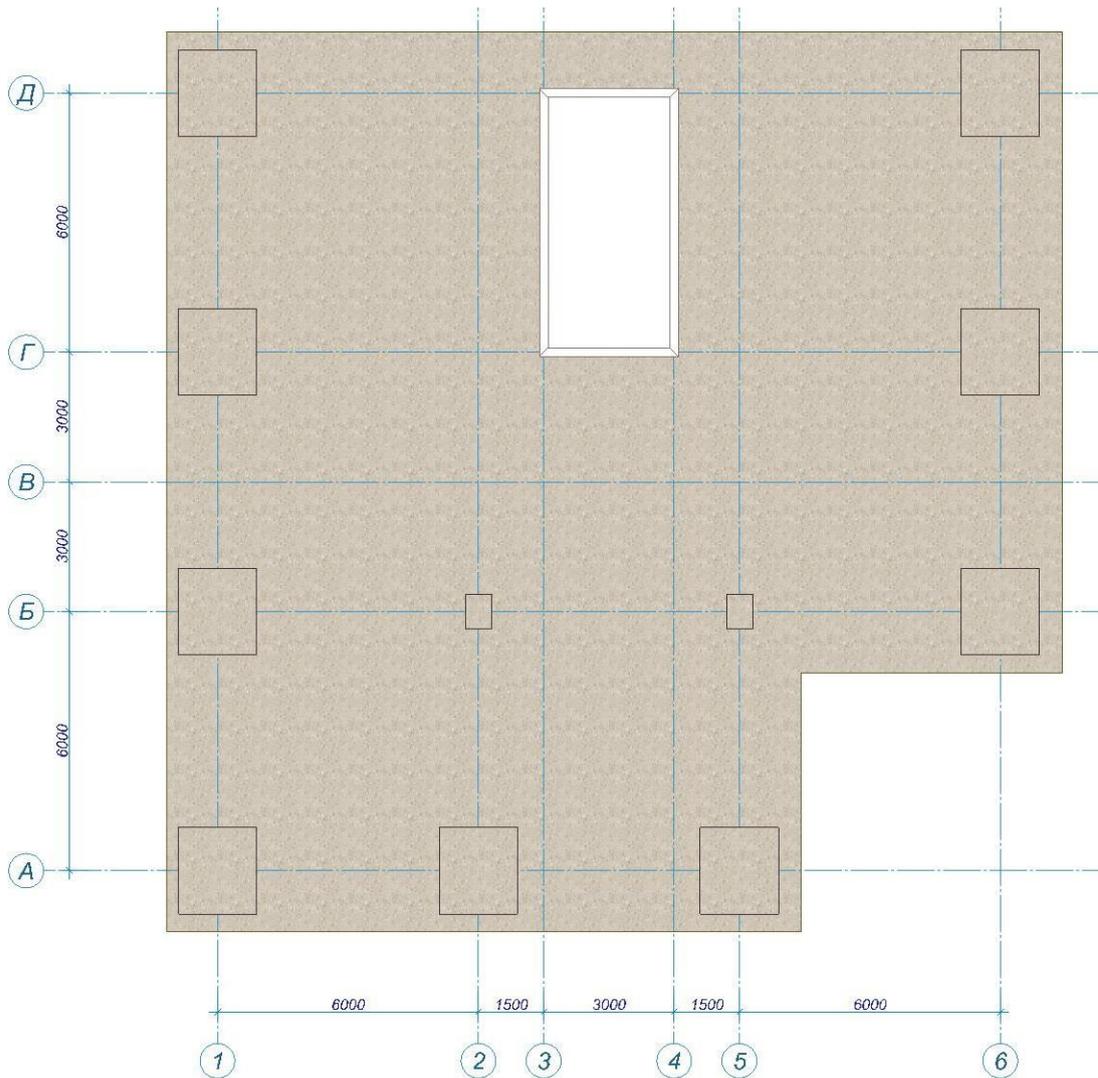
Расположение проема в плите перекрытия на виде сверху
